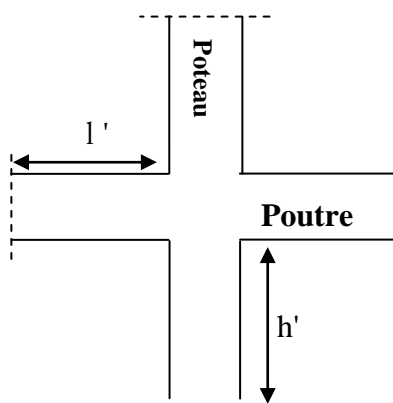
Zone nodale (nœud poutre-poteaux).
